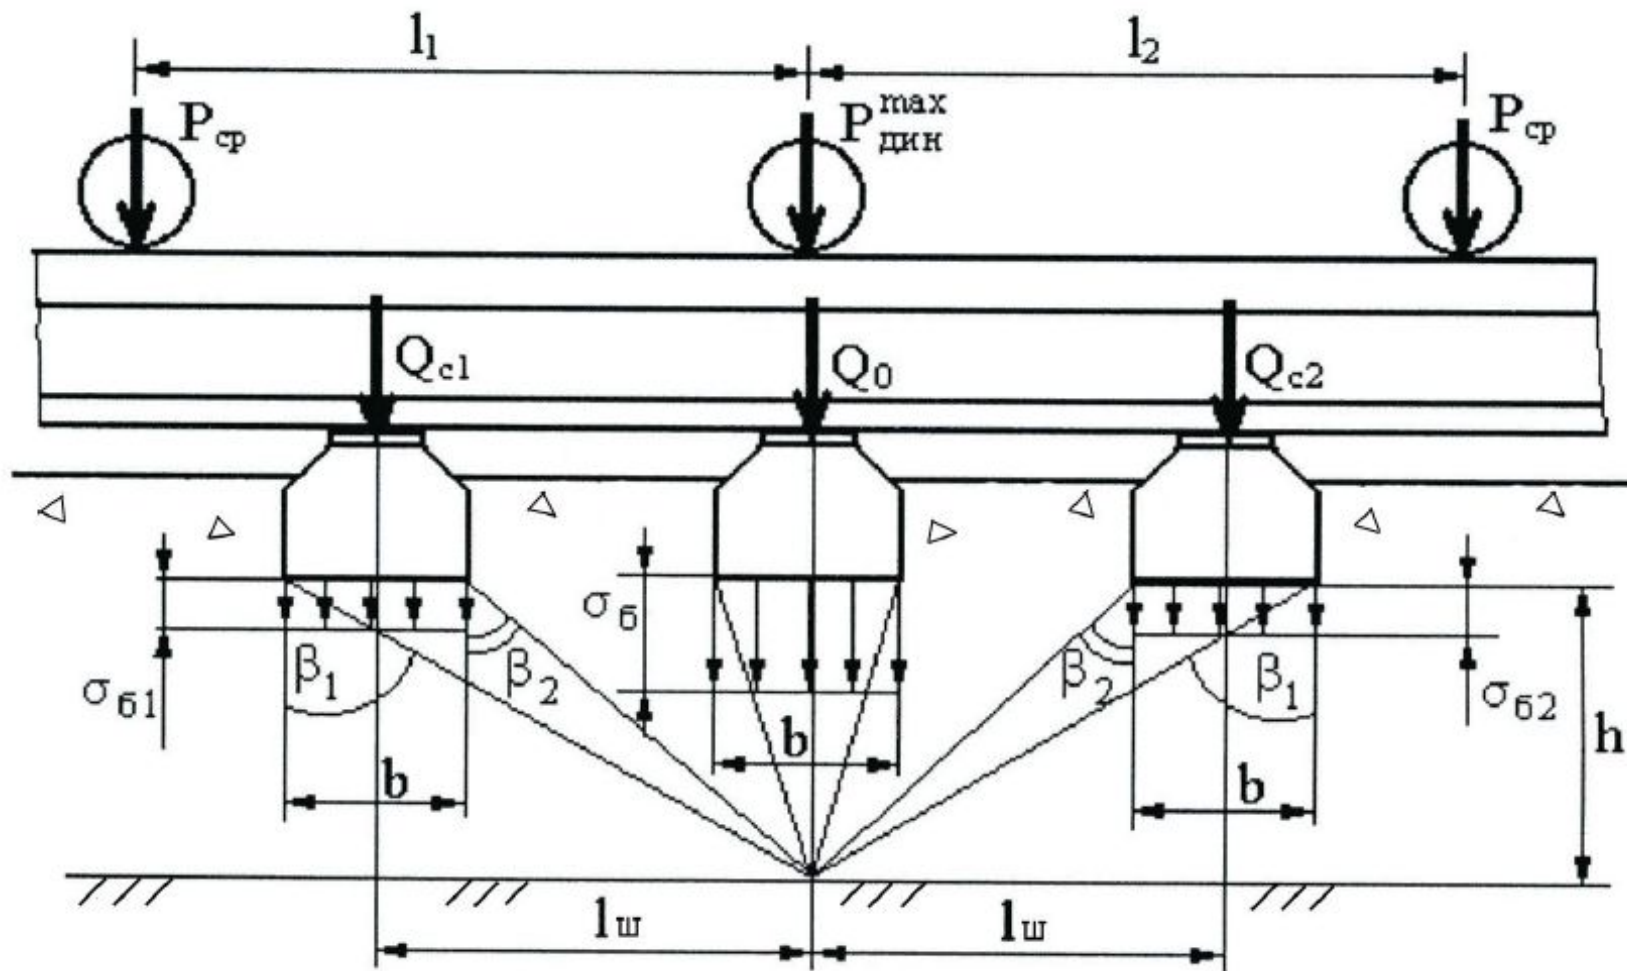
Схема расчета напряжений на основной площадке земляного полотна
